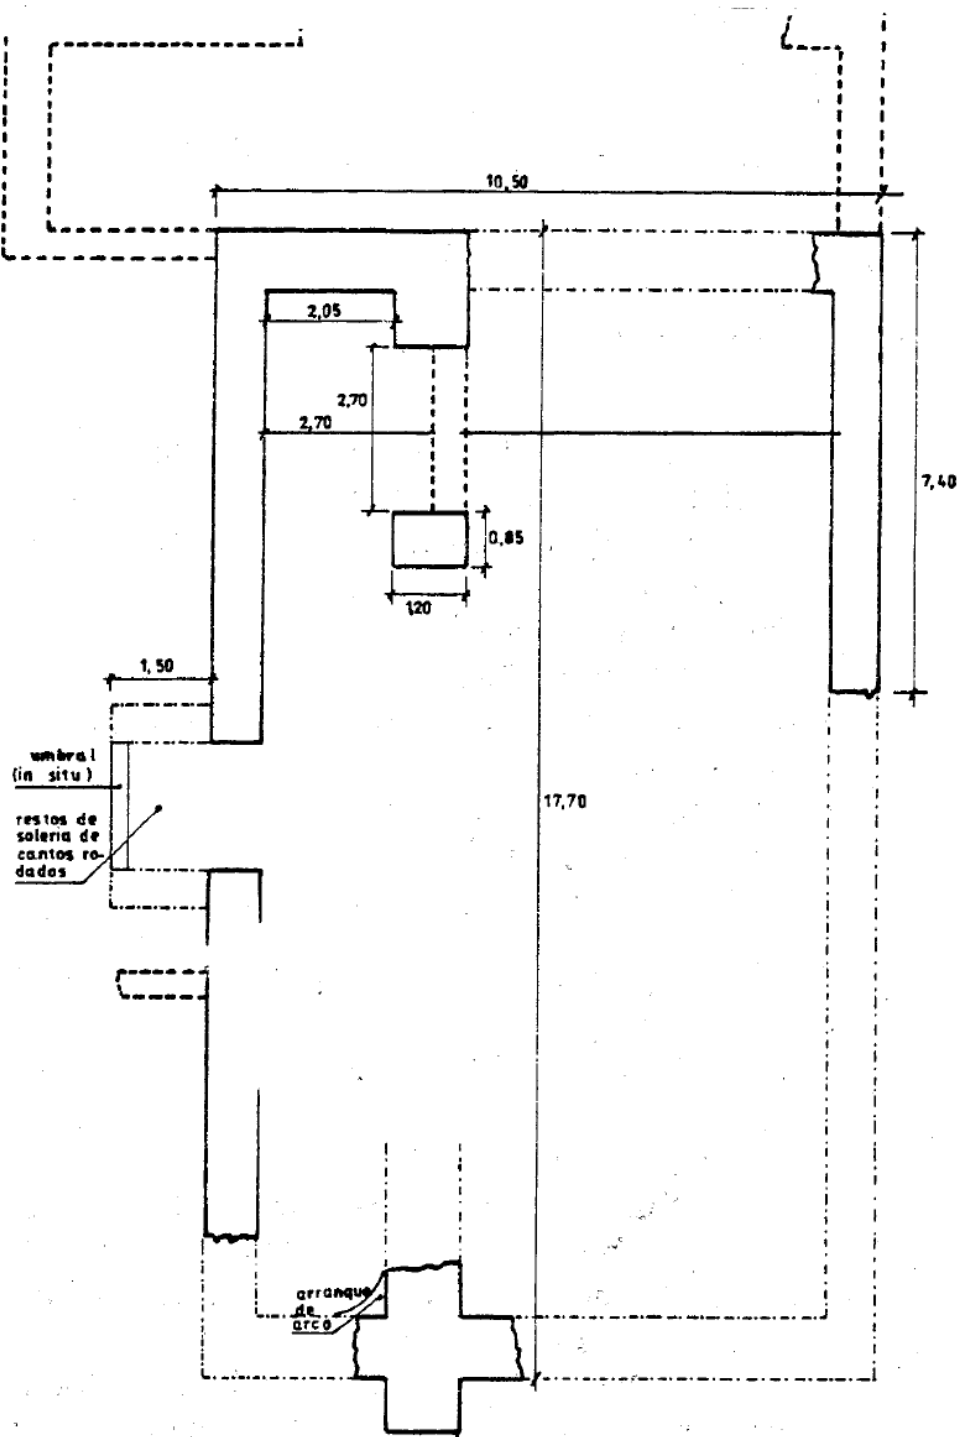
Plano de las estructuras hoy visibles (ORTIZ et alii: 1997: 37)
